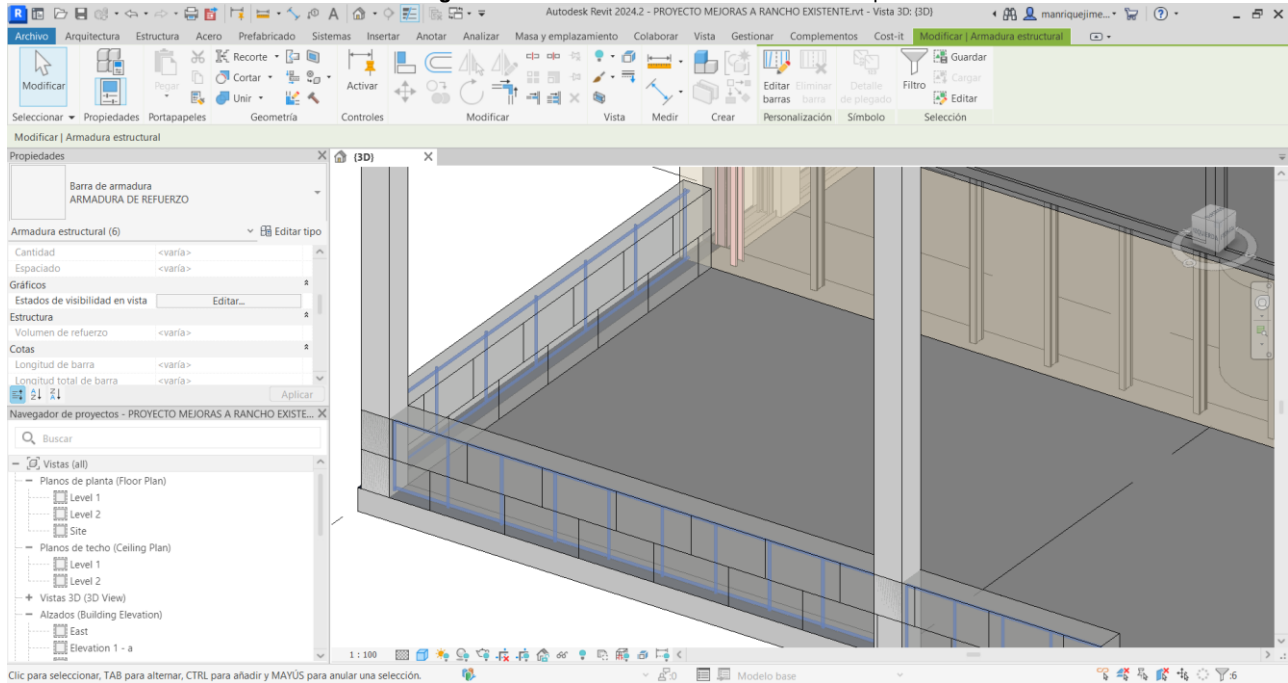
Detalle de malla electrosoldada en la losa de contrapiso desde el corte de sección 4.
